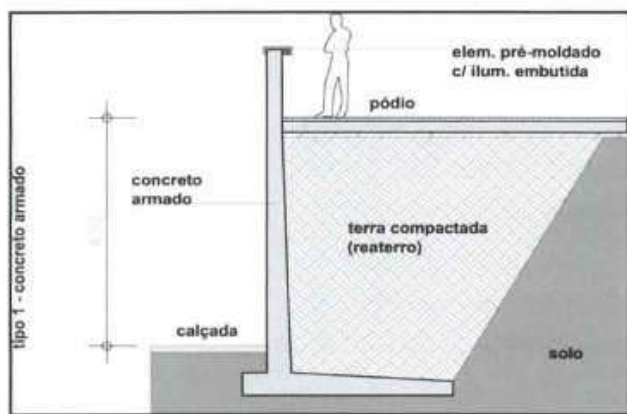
Corte típico muro, $h = 4,0 \text{ m}$
